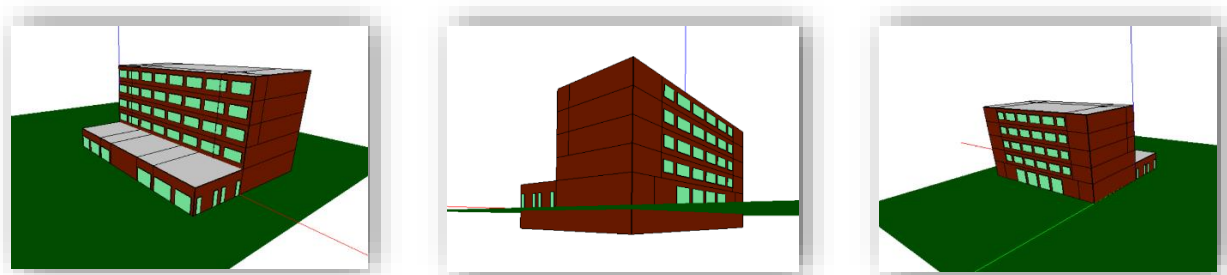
Vista sureste, noreste y noroeste extraídas de Genera3D
